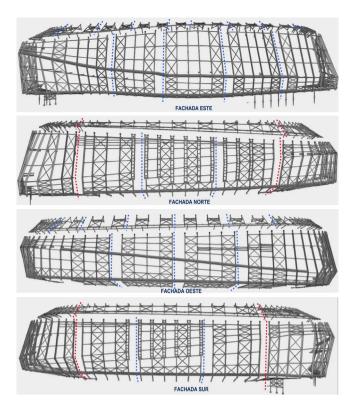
Juntas de dilatación en la fachada. en rojo, las principales entre edificios; en azul, las dispuestas entre módulos.
